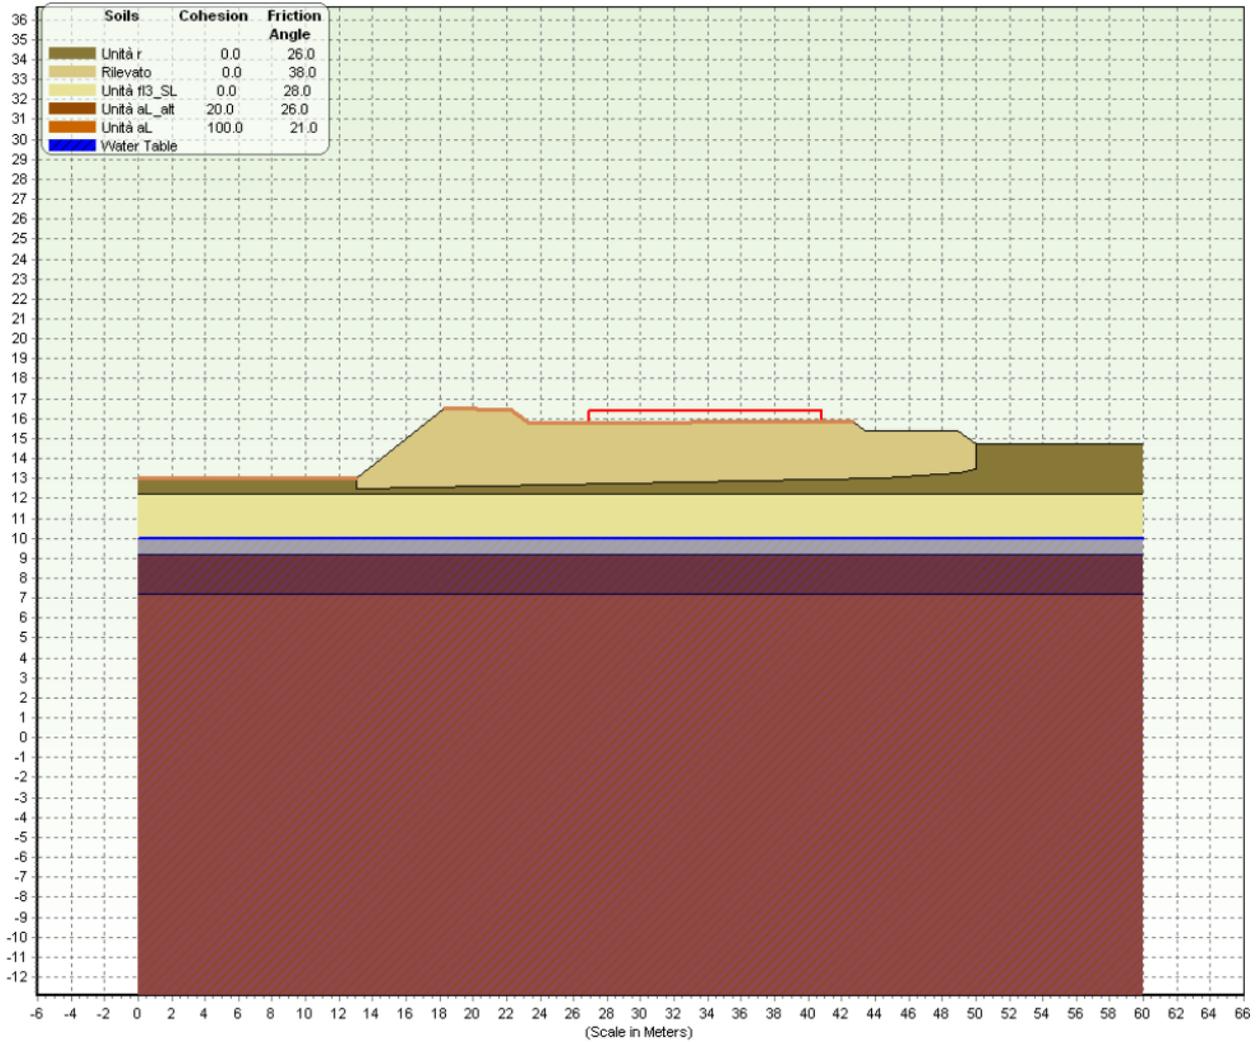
RI13 – Geometria della sezione di calcolo pk 36+700.00
